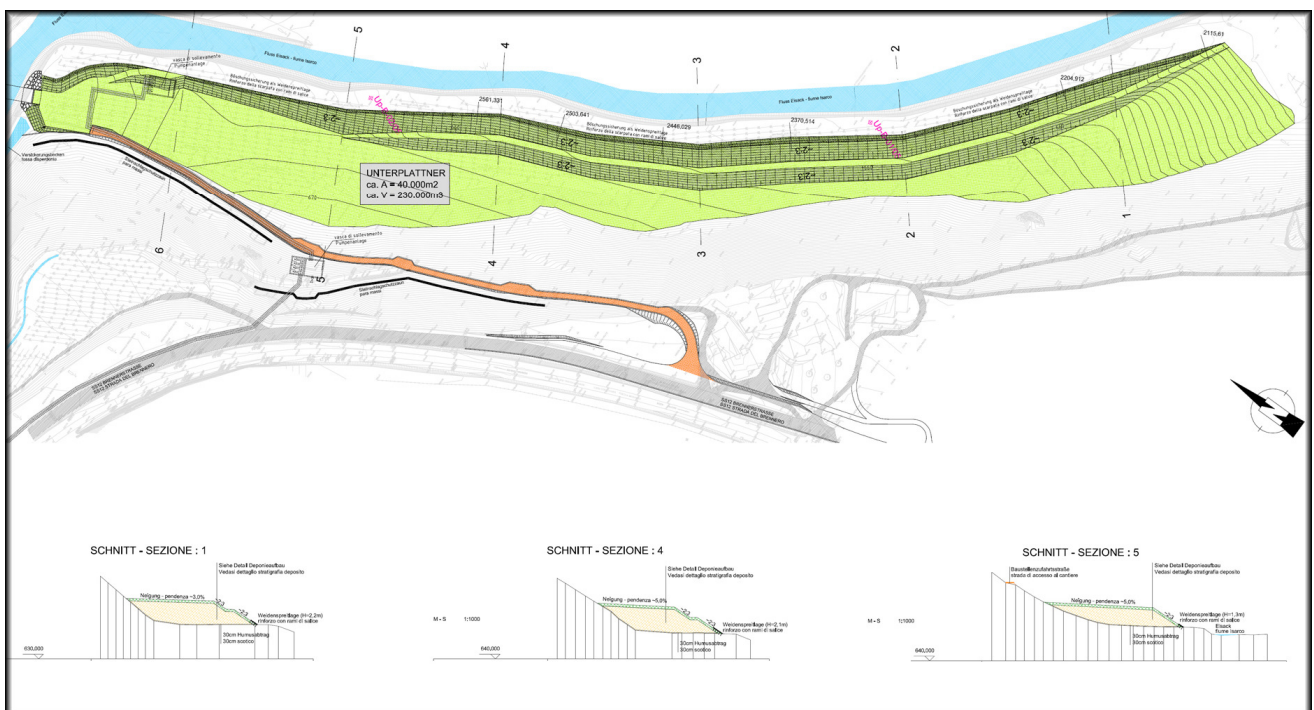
Lageplan und regelquerschnitt deponie Unterplattner
